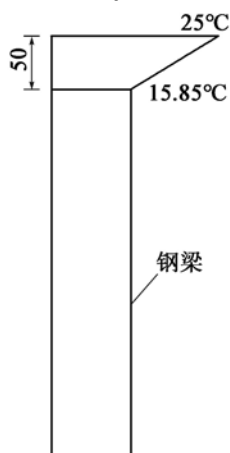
STC 温度梯度计算示意 (以升温为例) (尺寸单位: mm)
